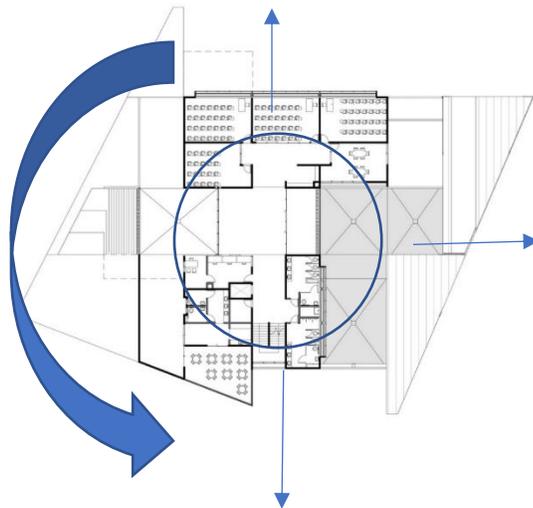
Planta Arquitectónica Centro Cívico Tirrases.
